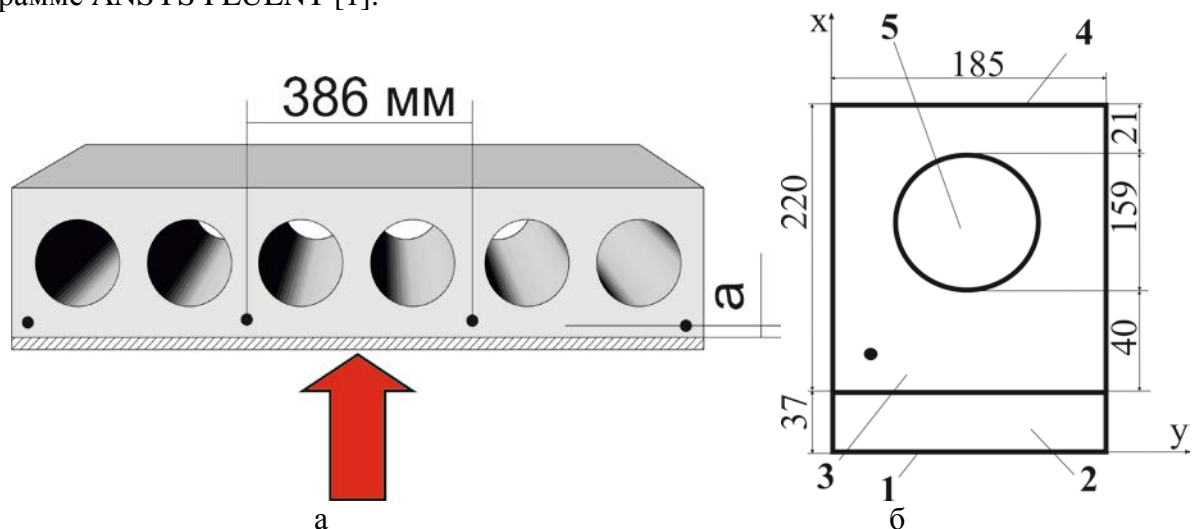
Общий вид многопустотного железобетонного перекрытия ПК 48-12-8т (а) и схема периодической части (фрагмента) плиты с покрытием, используемая в 2D-моделировании (б)
